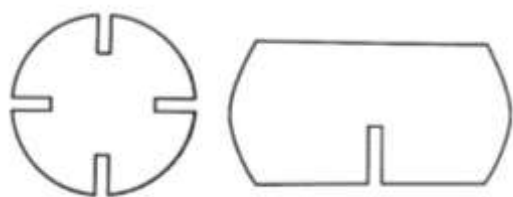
Madeira redonda. Entalhes para controlar fendas. Autor: Paulo Barreto Cachim
